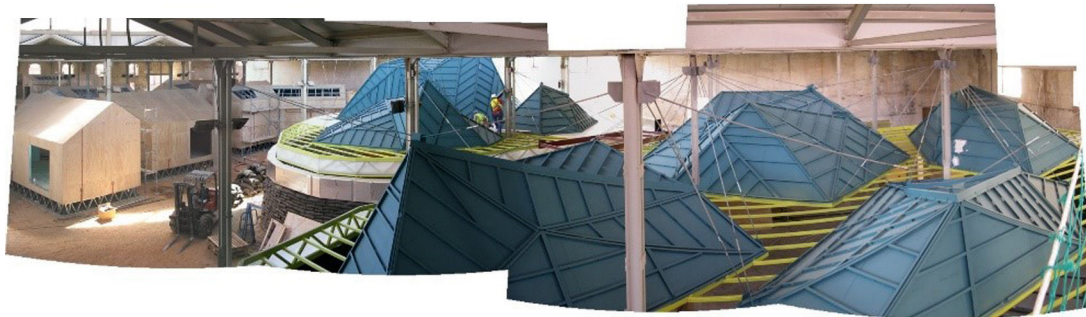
Nuevas estructuras de acero colgadas de la estructura principal de la nave.
